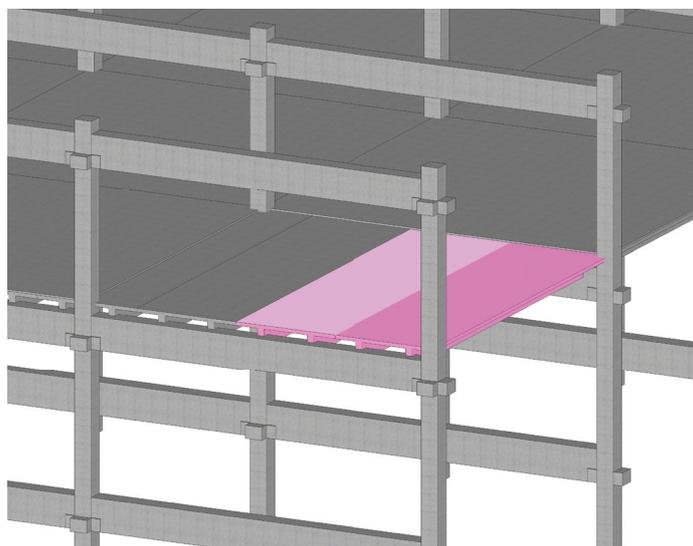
3D-Aufmaß des Stahlbetonkellers. Quelle: Anselm Schön
